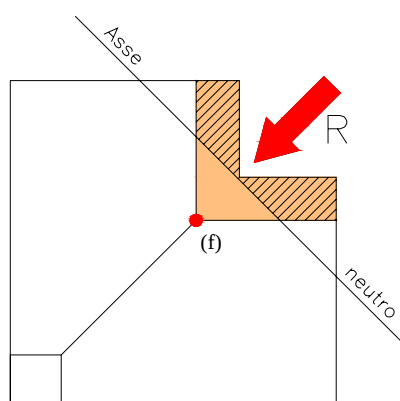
Particolare planimetrico della sezione alle reni di volta a padiglione con il filo (f) della nervatura situato in zona tesa.
